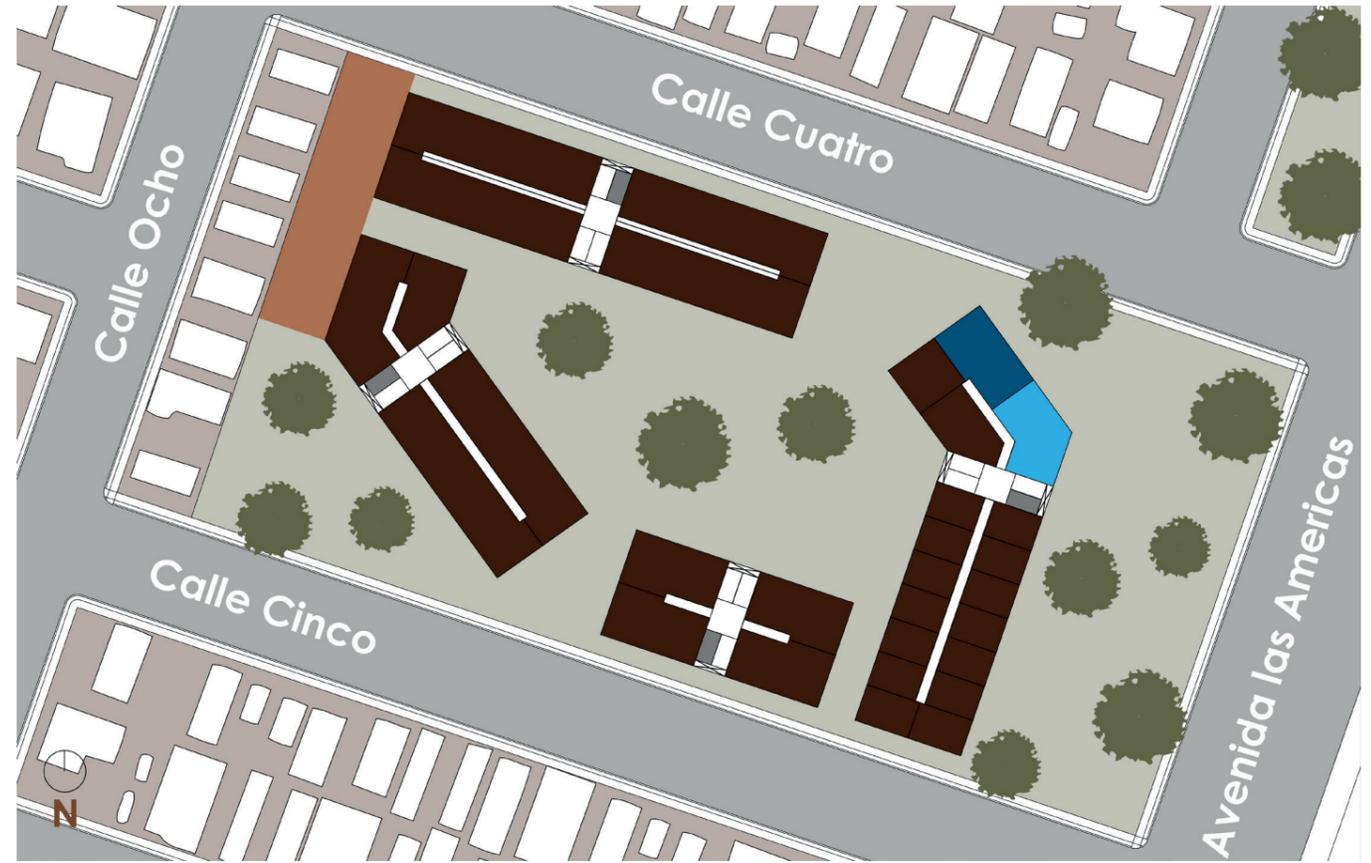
Planta de propuesta programática preliminar, Planta piso tipo, Alto Hospicio. Elaboración propia. 2024.
